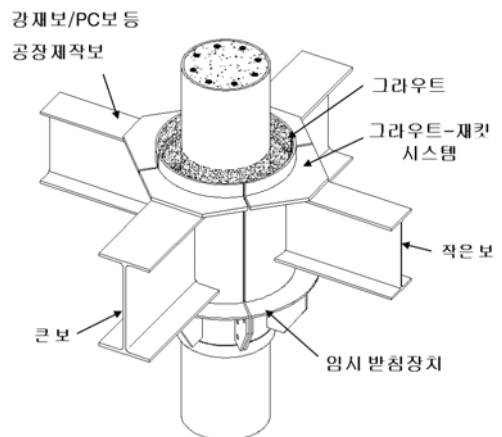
ES-TD Grout-Jacket Connection System의 기본구성 예
